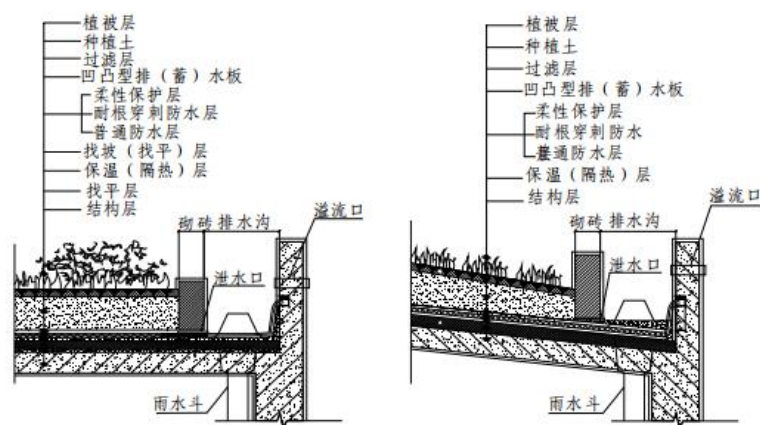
种植屋面构造示意图：（a）平屋面；（b）坡屋面
